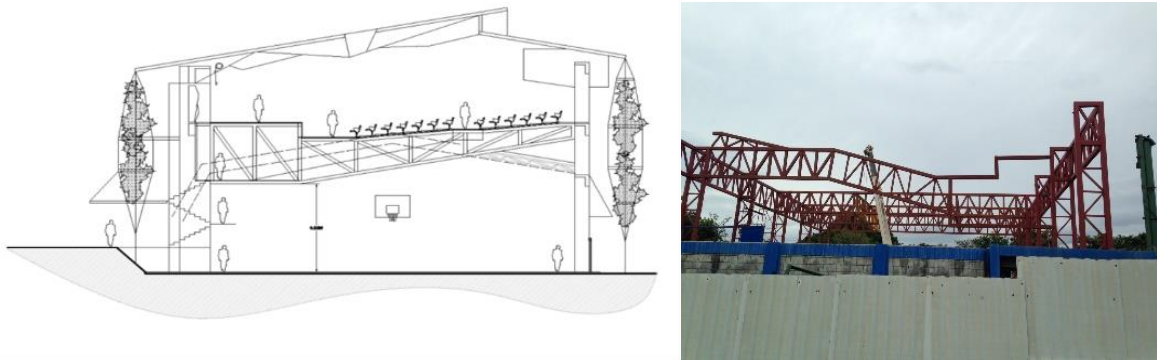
Auditorio NG. (2018) Sección propuesta y estructura en construcción. Fotografía por el autor.
